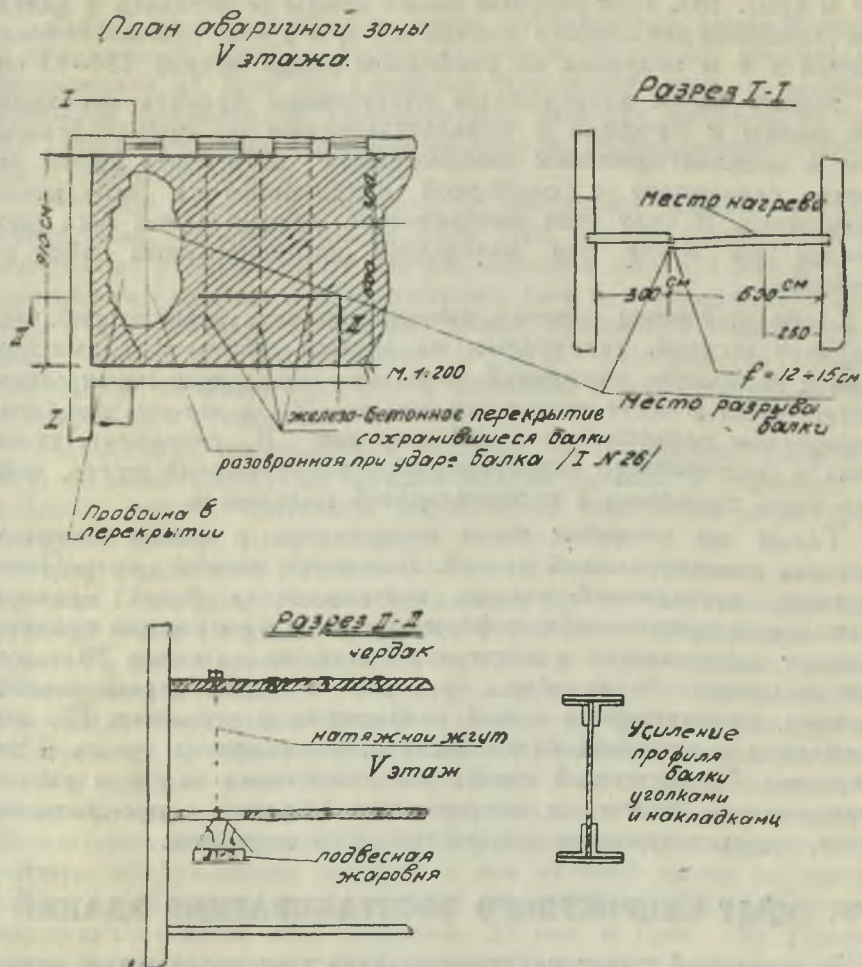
Схема восстановления аварийных балок перекрытия в доме № 18 по Моховой ул.
